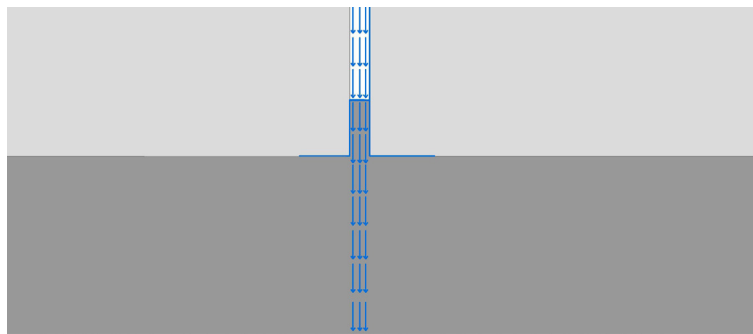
Esquema de infiltración de agua por quiebro de junta vertical rebajada de 5 mm. Vista frontal desde interior de la cámara de aire.
